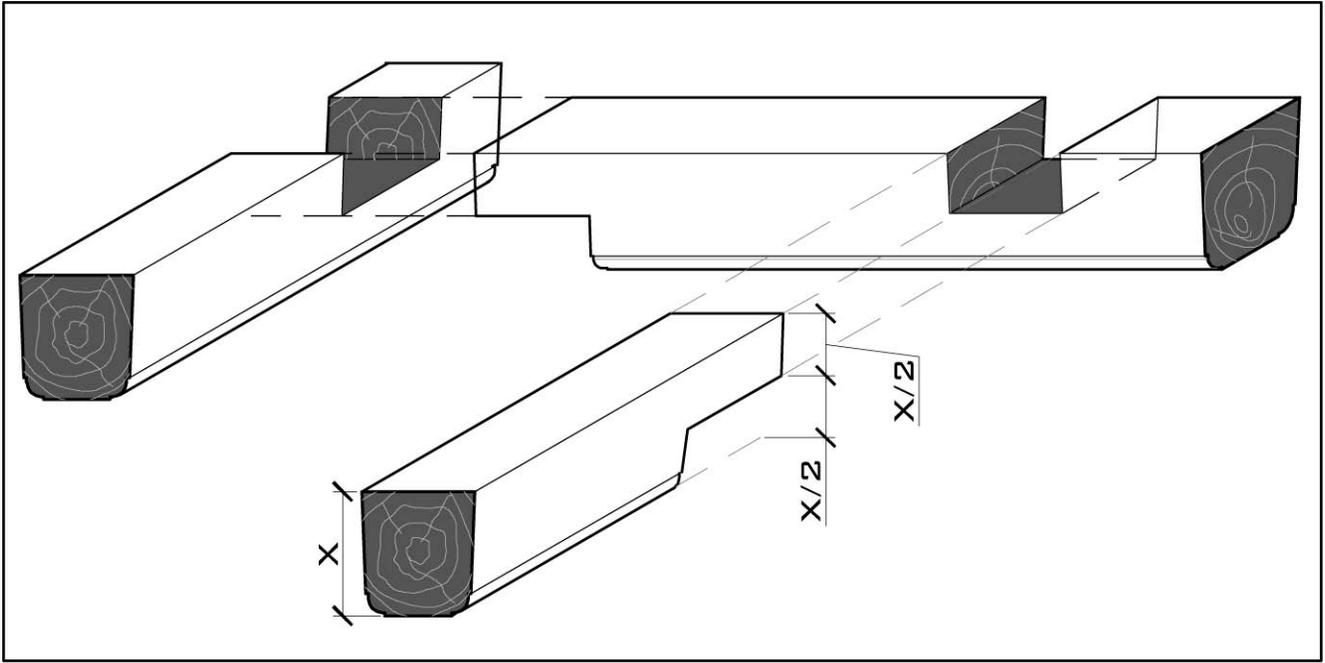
Assemblage des poutres et d'un linteau au dessus d'une fenêtre
